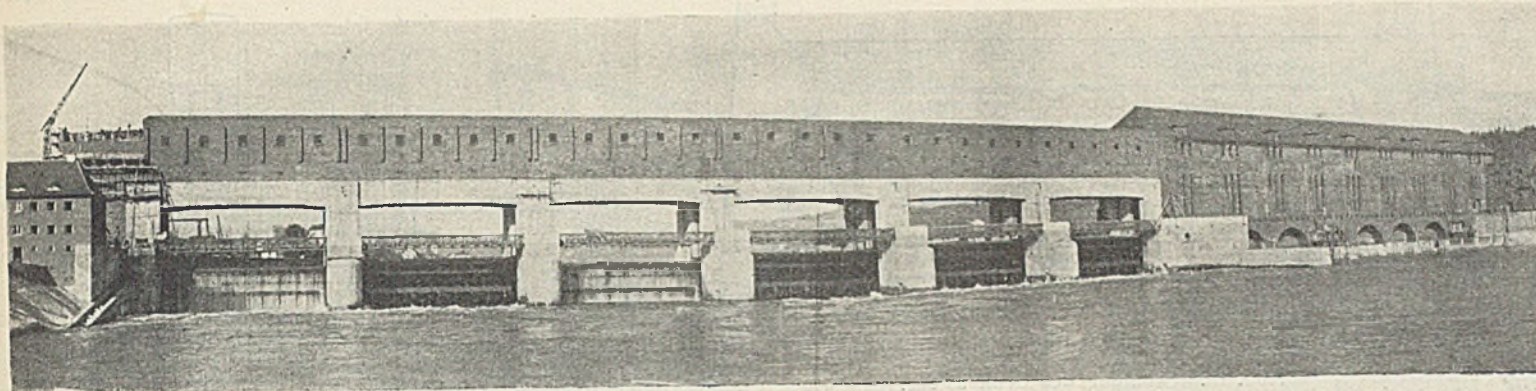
Staustufe Kachlet bei Passau. Blick vom Unterwasser aus.
